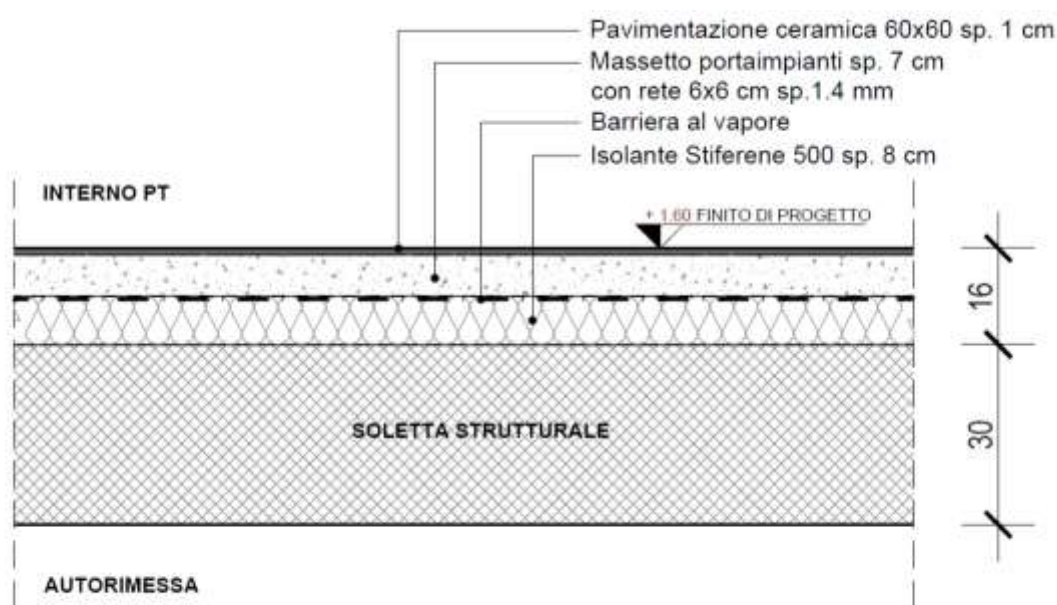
dettaglio della porzione di solaio a piano rialzato previsto sopra l'autorimessa
